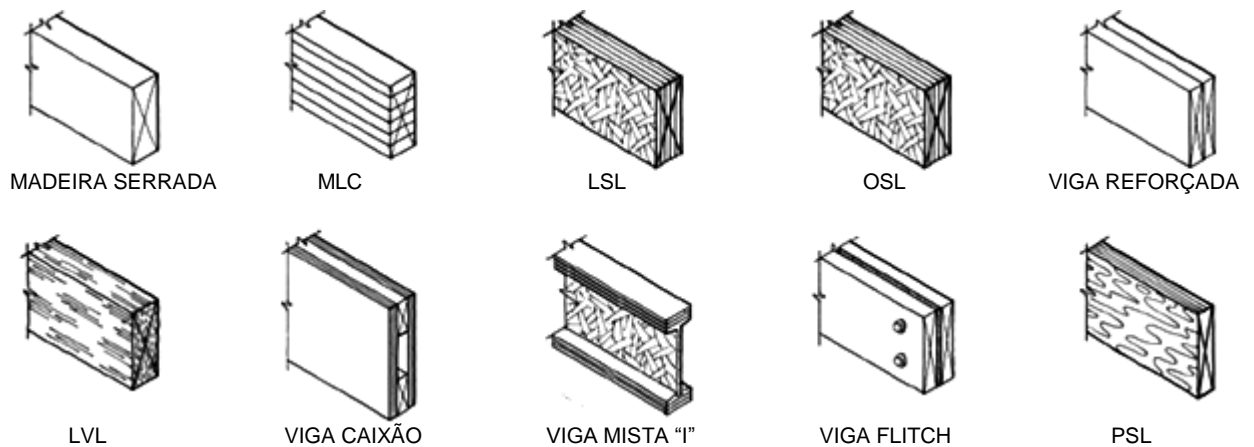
Exemplos de vigas de madeira. Fonte: Adaptado de Thallon (2008).
